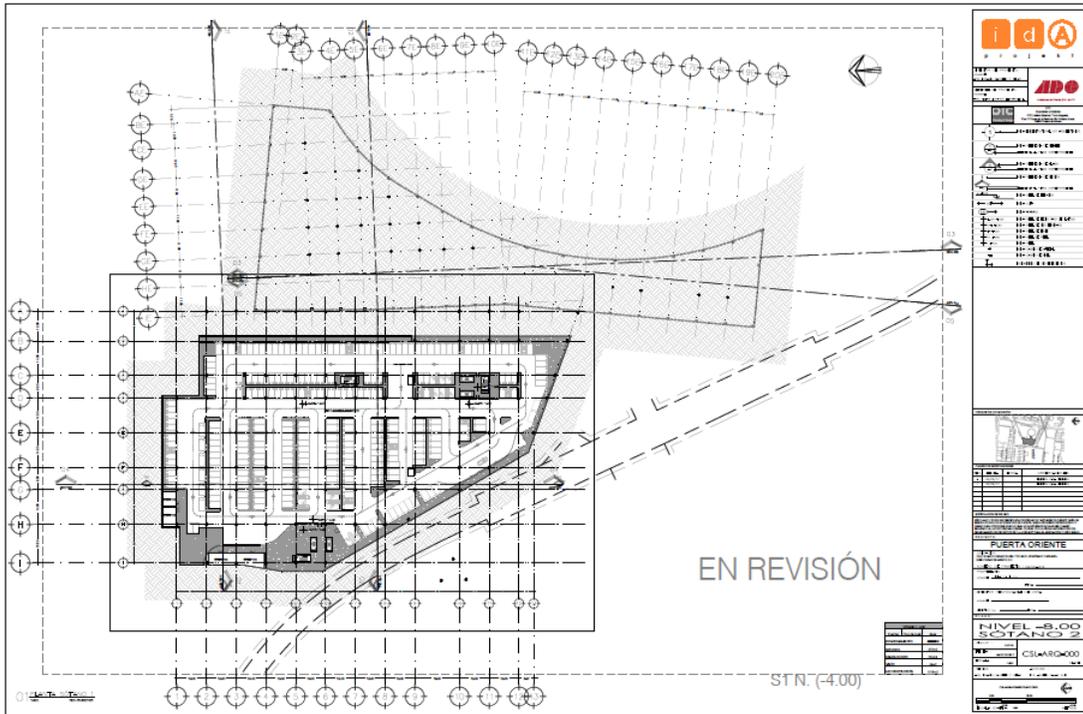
Nivel Sótano -2. Fuente: Puerta Oriente por IDA Projekt.
